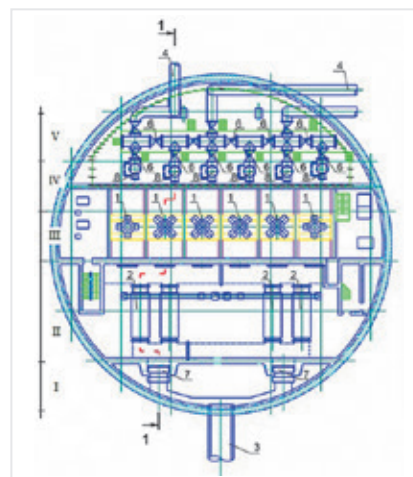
Принципиальный вид канализационной насосной станции (план подземной части): 1 — насос канализационный вертикальный; 2 — грабельная решетка (мелкопрозорная 5–50 мм); 3 — подающий трубопровод; 4 — отводящий трубопровод; 5 — задвижка на подающем трубопроводе; 6 — задвижка на отводящем трубопроводе; 7 — щитовой затвор с электроприводом; 8 — обратный клапан; 9 — нагнетательный, выходящий из КНС трубопровода
